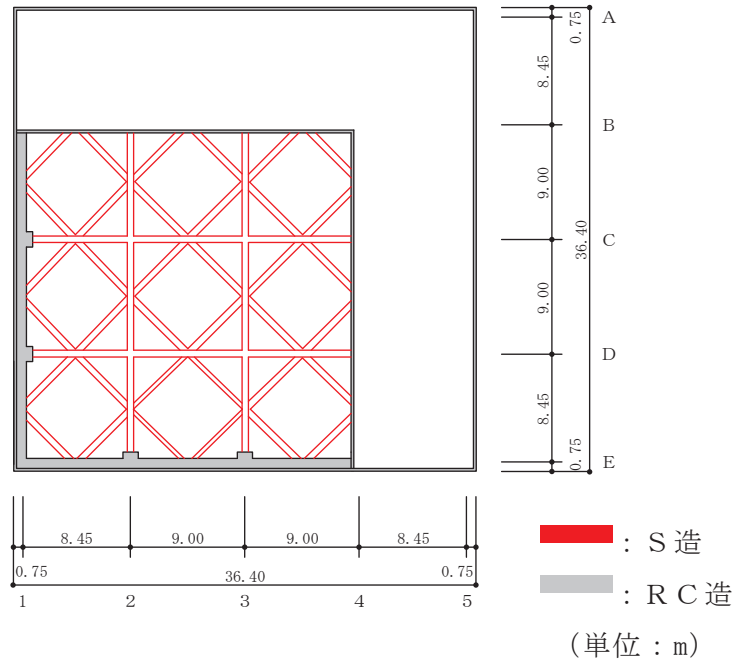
(5) 緊急時対策建屋の概略平面図 (0.P.75.9m)
